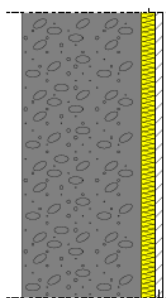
Pormenor da parede interior – Par\_Int\_5.
